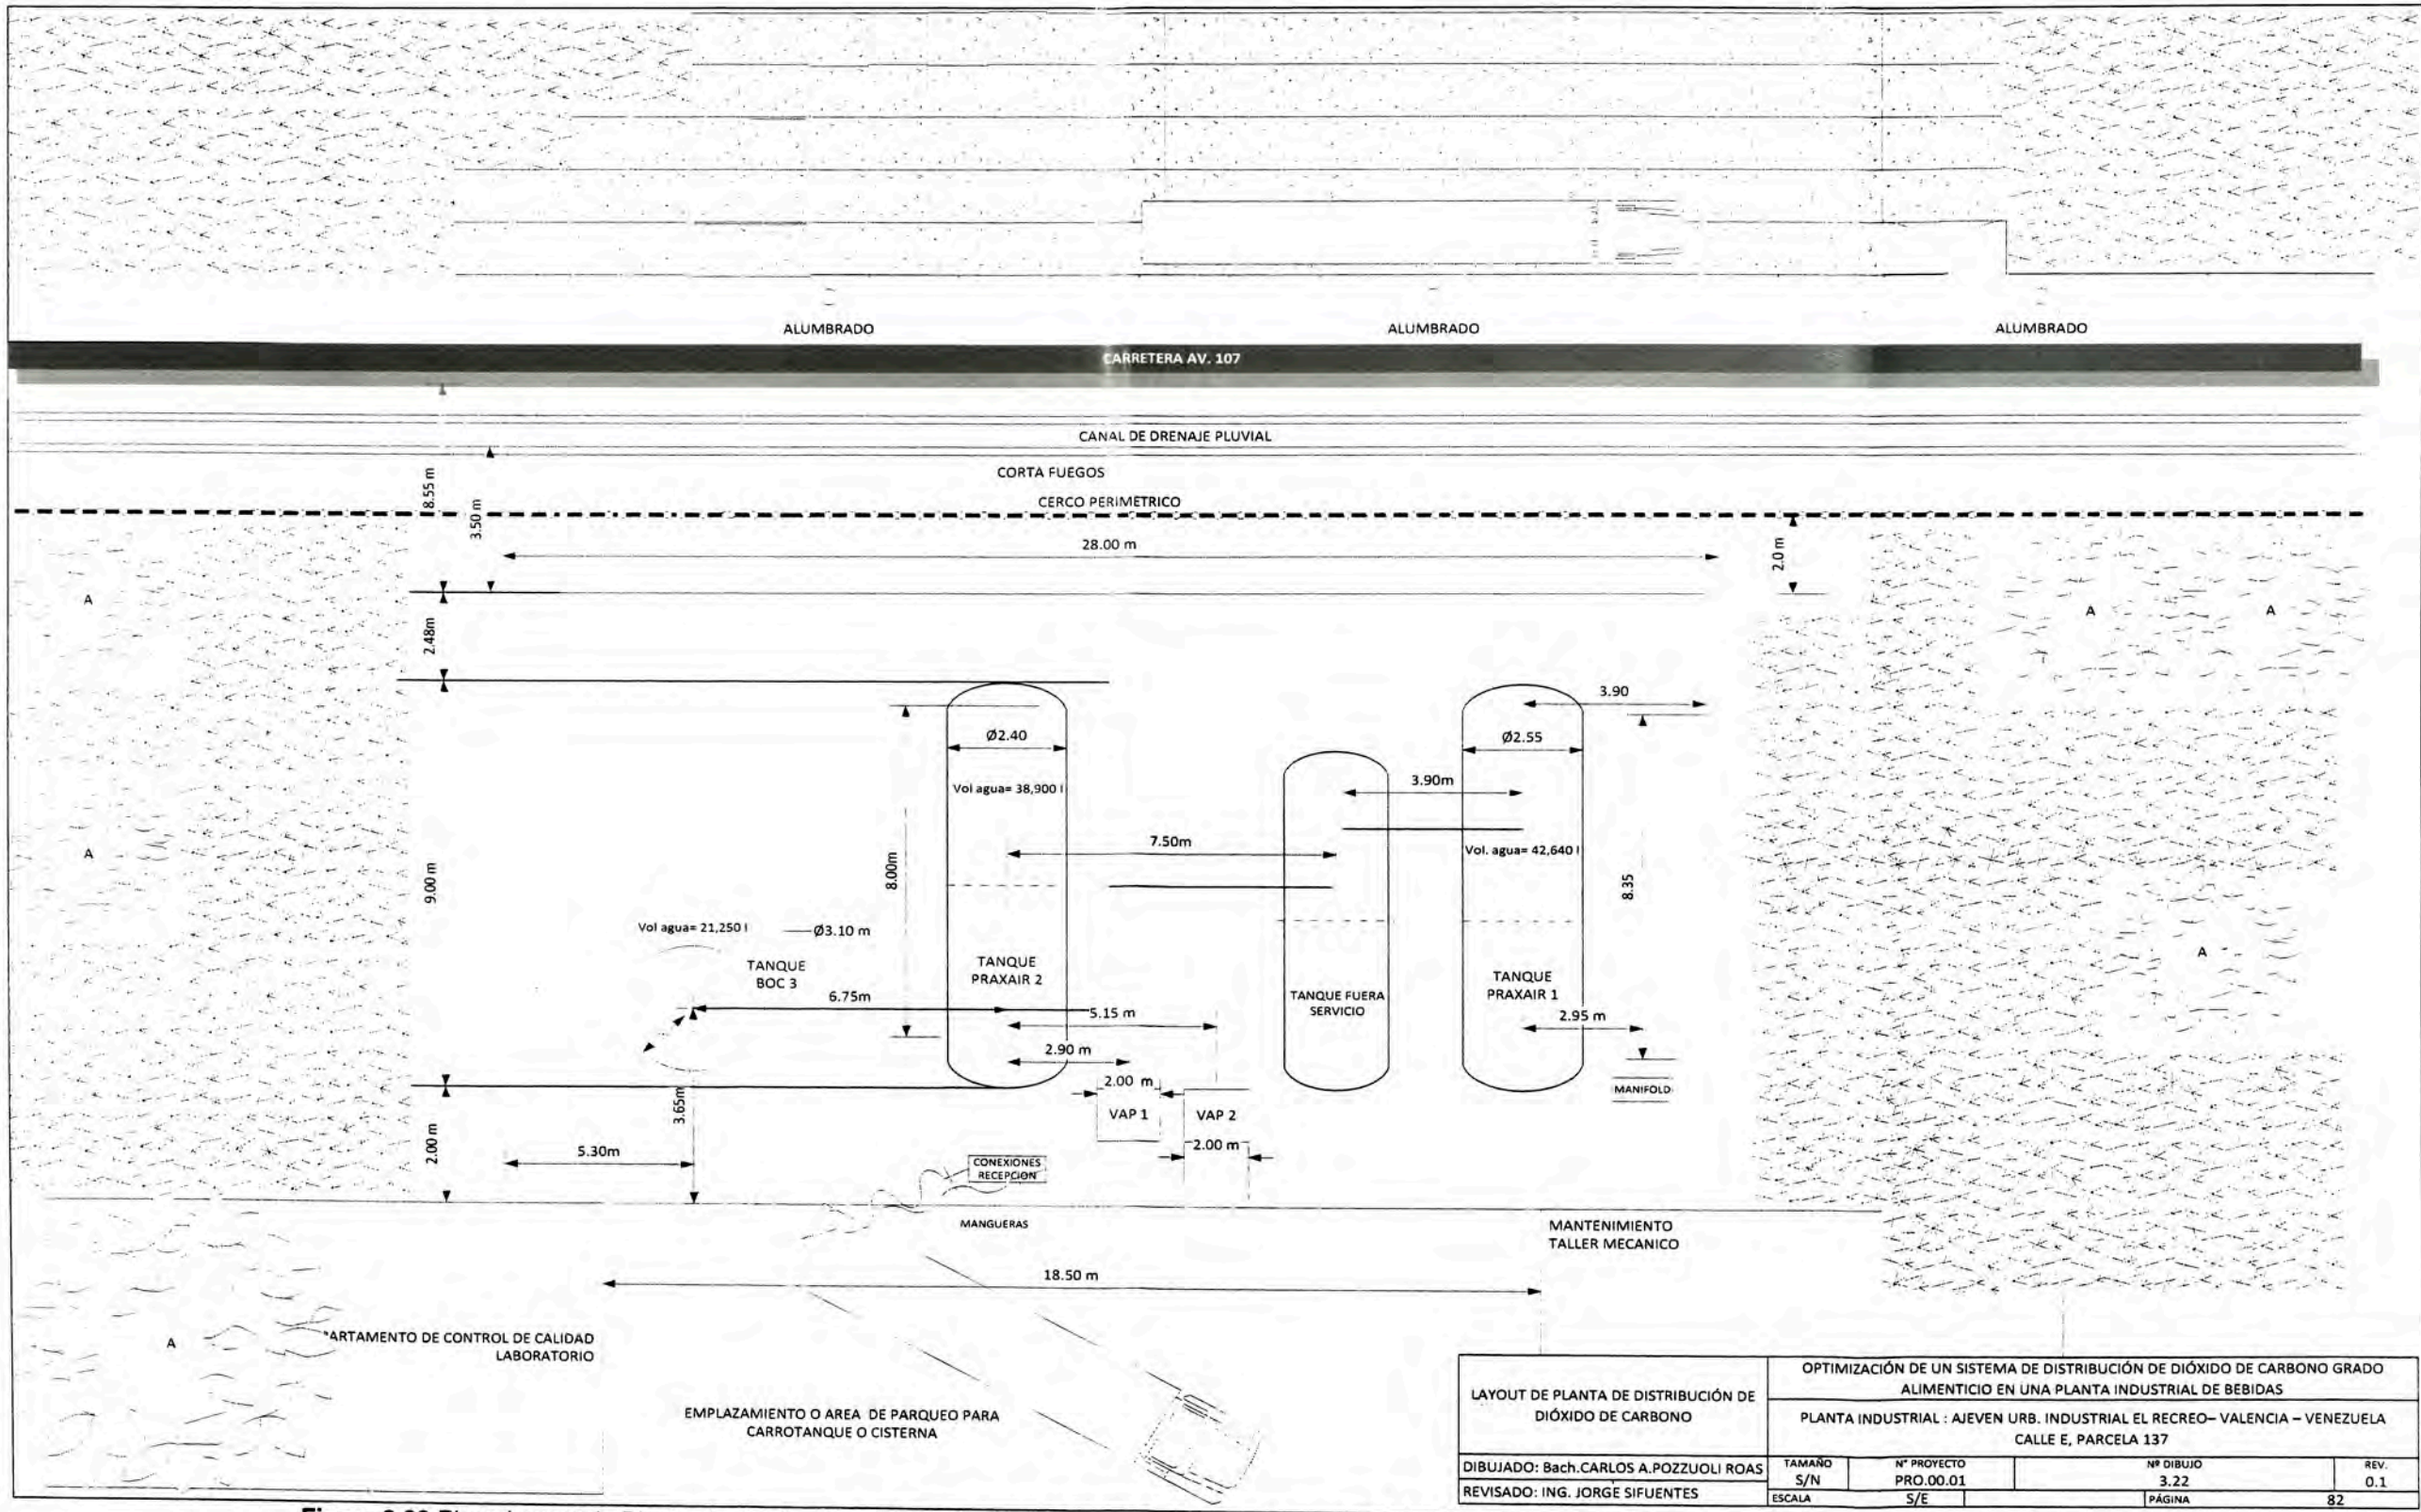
Plano Layout de Planta de distribución de dióxido de carbono de la Planta Industrial AJEVEN C.A. – Urb. El Recreo - VALENCIA – VENEZUELA
